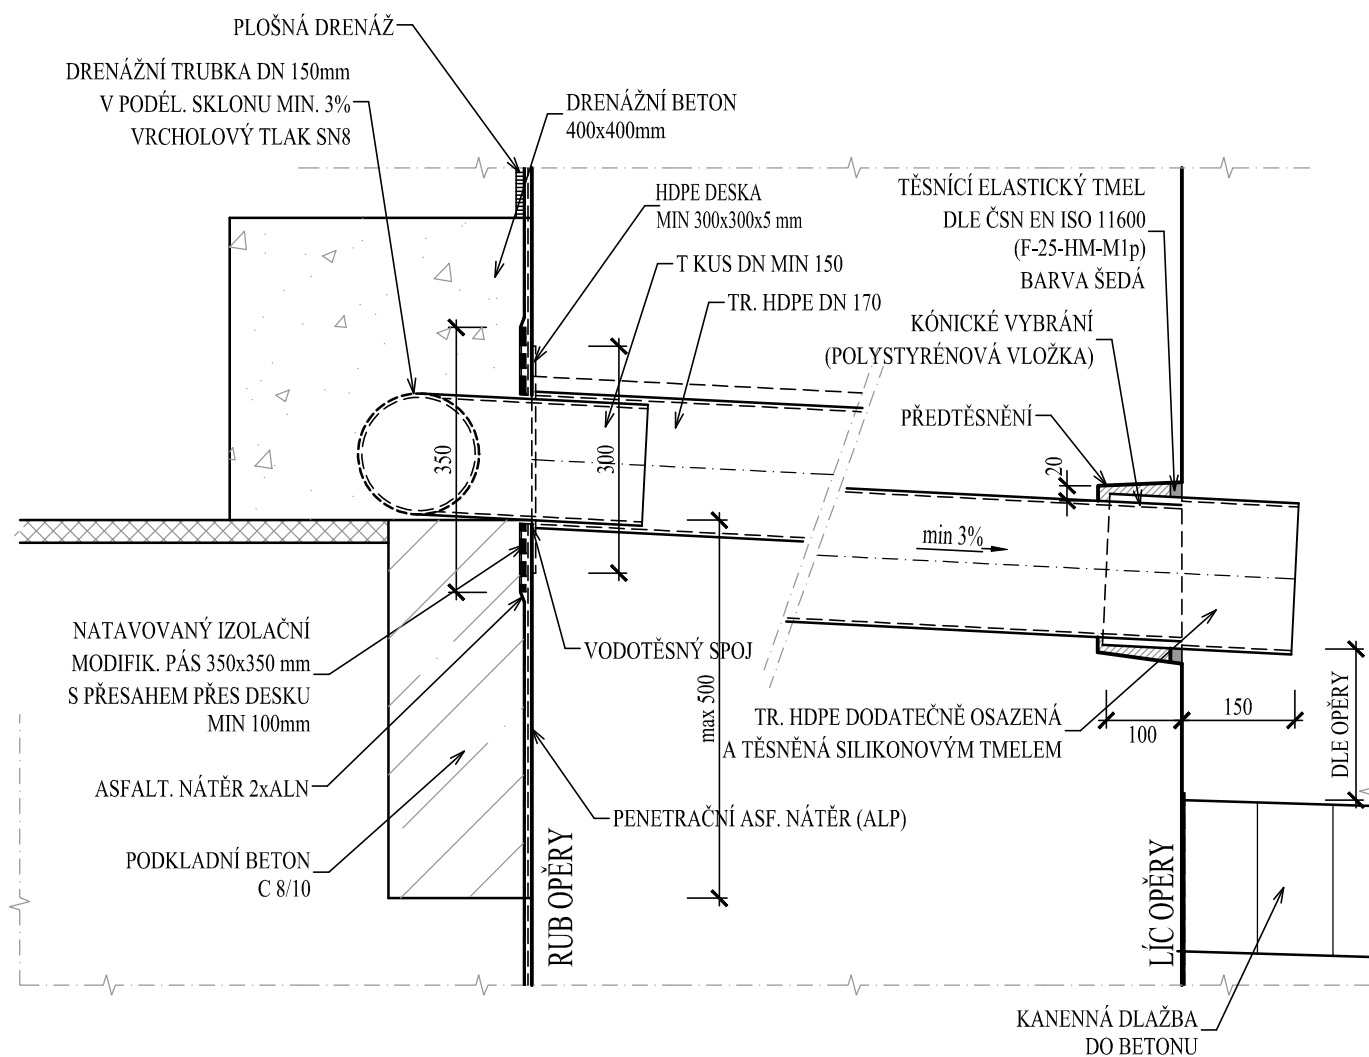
# DETAIL ODVODNĚNÍ RUBU OPĚR - DRENÁŽ ZA OPĚROU
